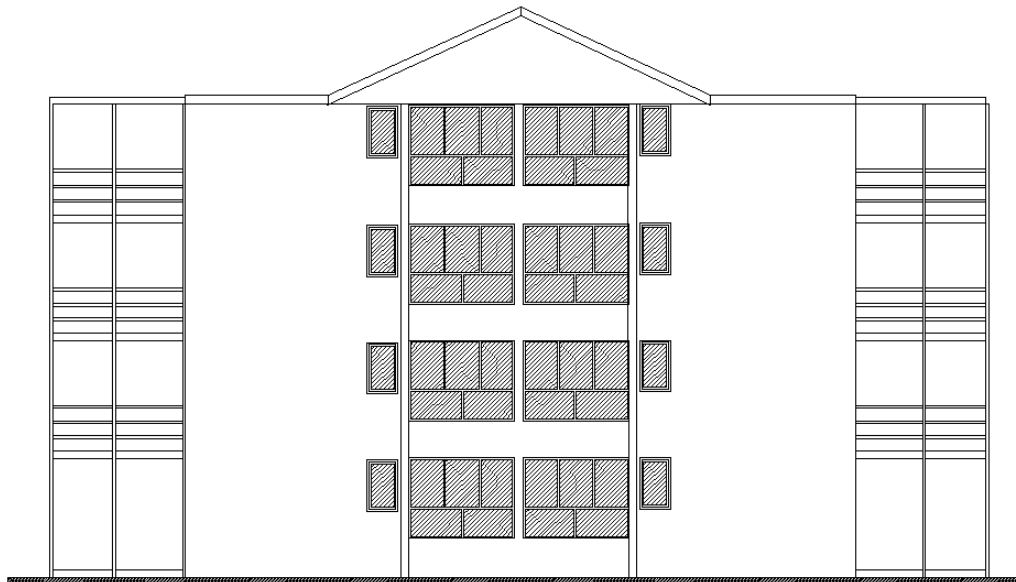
9. Elevación fachada secundaria del edificio de 4 pisos
